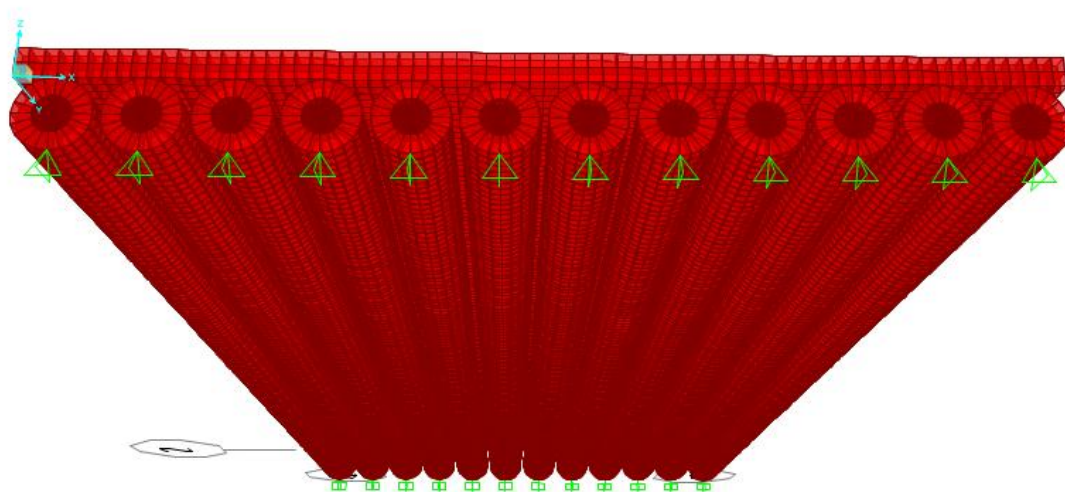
Vista em três dimensões da parte inferior do tabuleiro de madeira-concreto para os modelos 1 e 2. Fonte: O autor.
